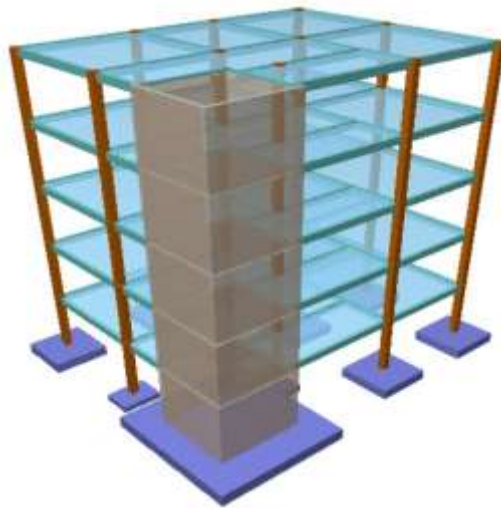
Pórtico de hormigón armado con muro estructural de ascensor. Tomado de (Reyes, 2014).
